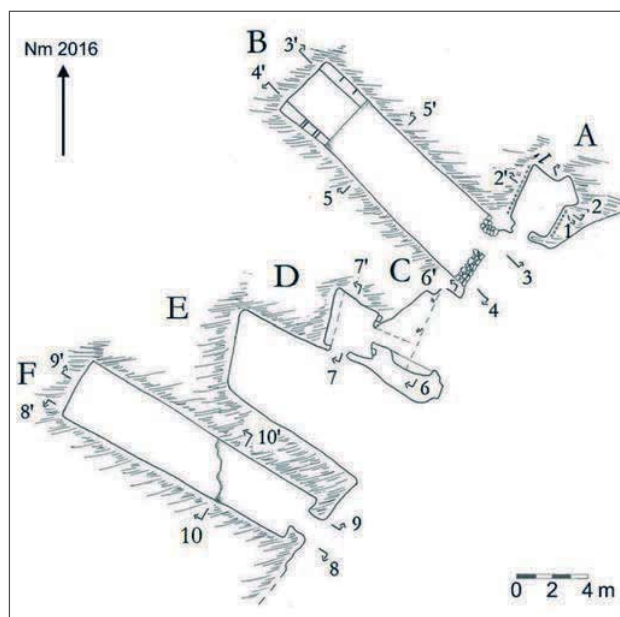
Pianta insediamento rupestre su Fosso Spinetto (schizzo B. Bottacchiari, 2016).
